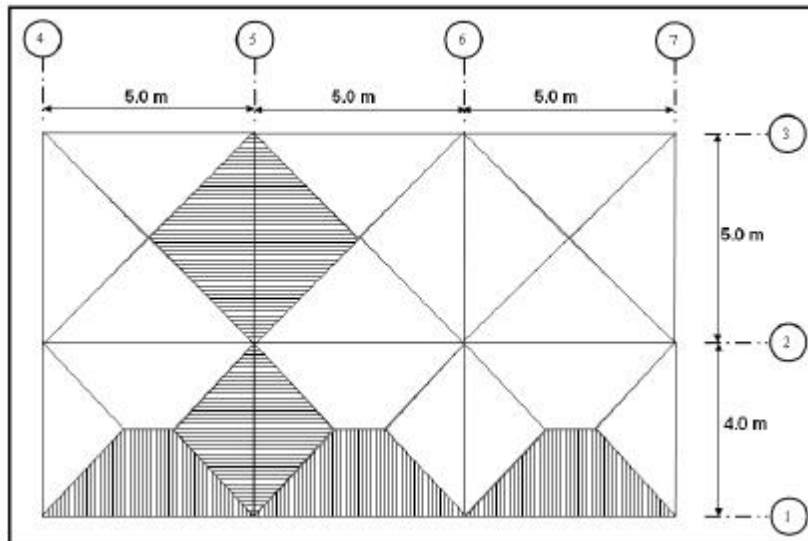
Vista en planta de un edificio que tiene 7 pórticos ortogonales
